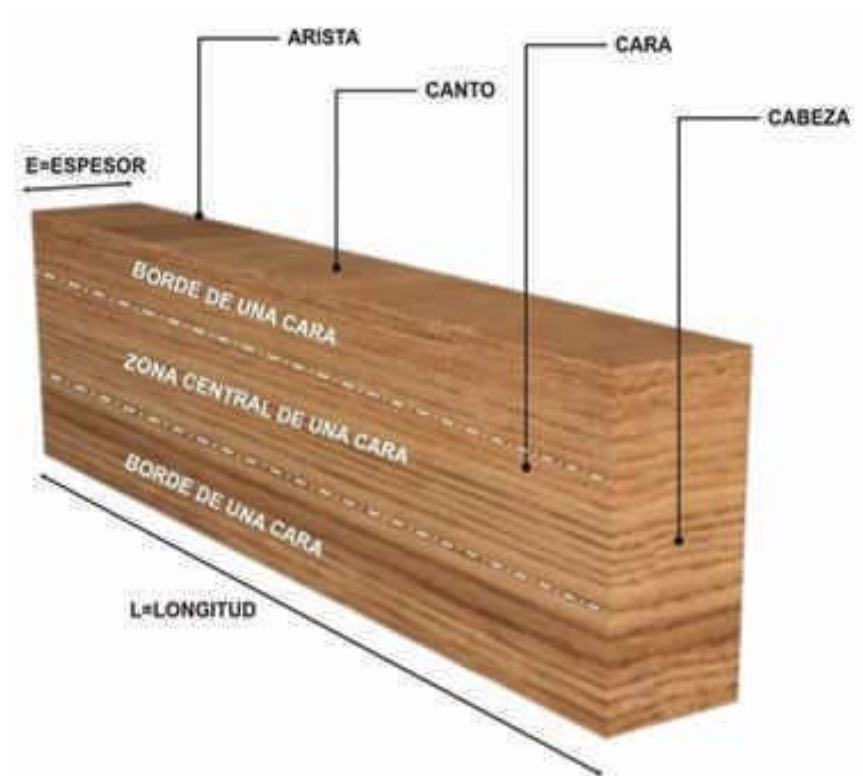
Términos utilizados para definir la geometría de una pieza de madera.
